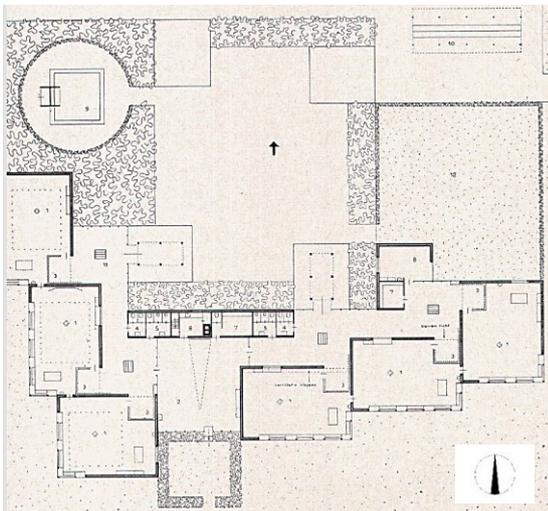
Aldo van Eyck, Schulhaus in Nagele (NL), 1958, Grundriss
